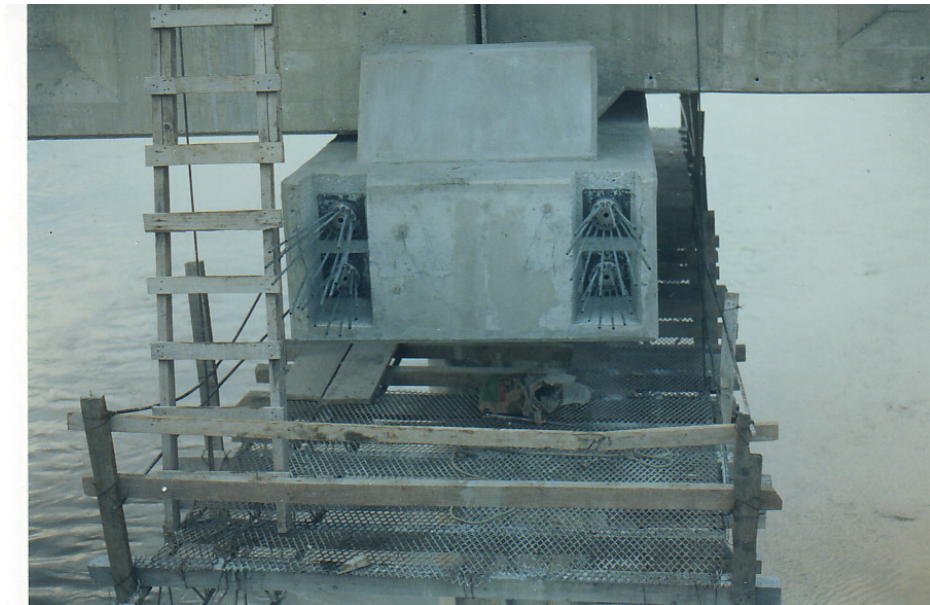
detalle de la instalación de dos gatos para tensar la viga simultáneamente a fin de evitar esfuerzo de torsión en la viga y la pila
